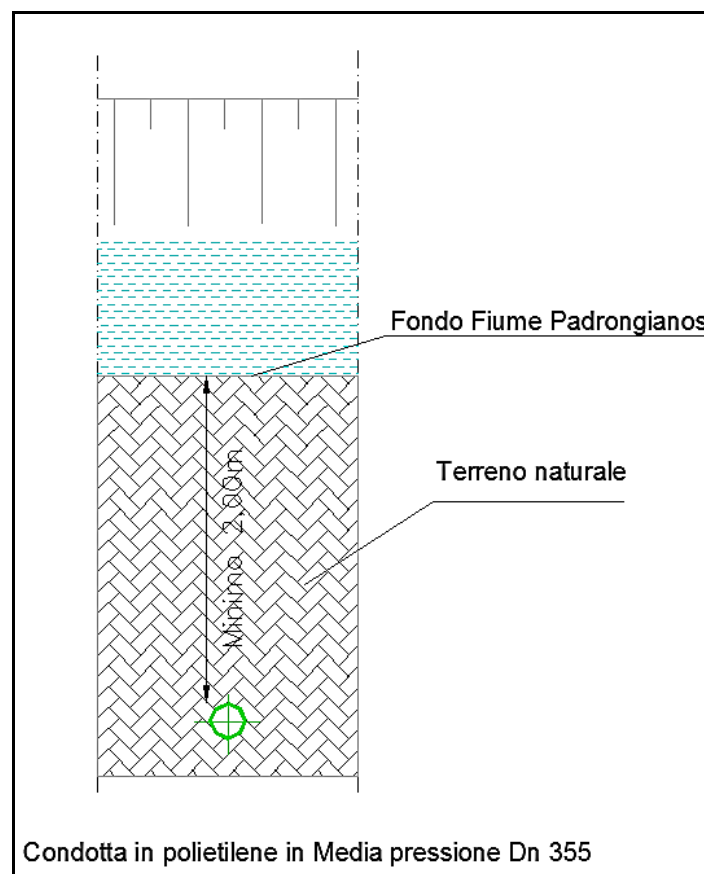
Sezione di progetto in corrispondenza del letto dell'alveo inciso.
